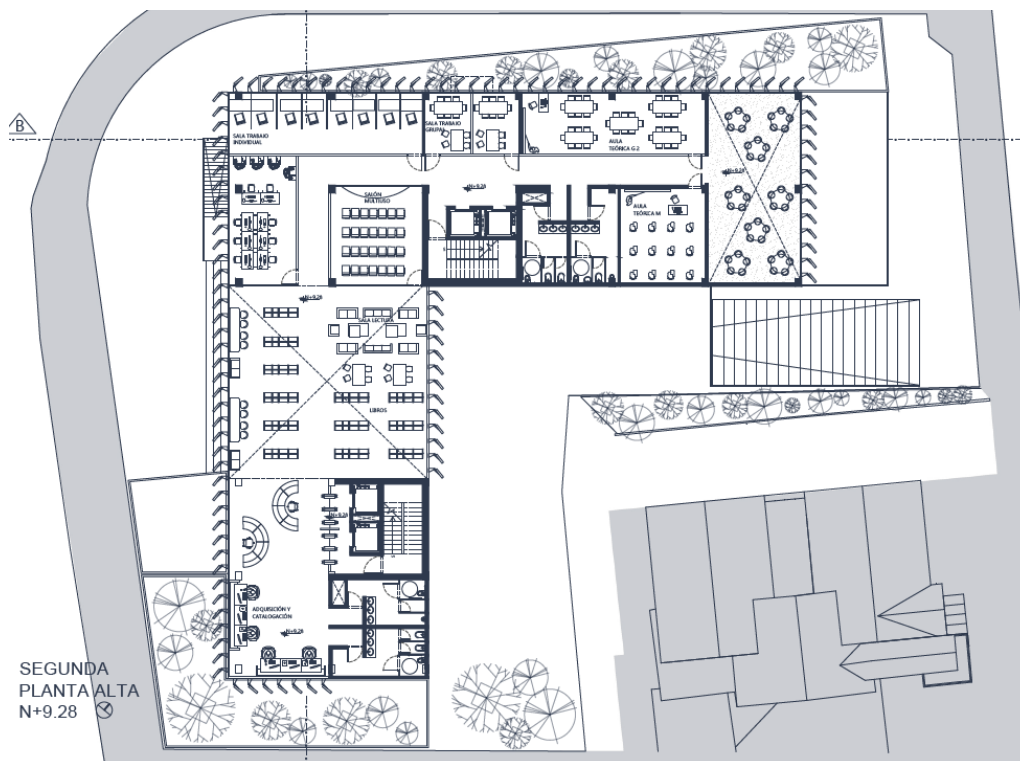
Segunda Planta Alta N+9.28. Autoría propia
